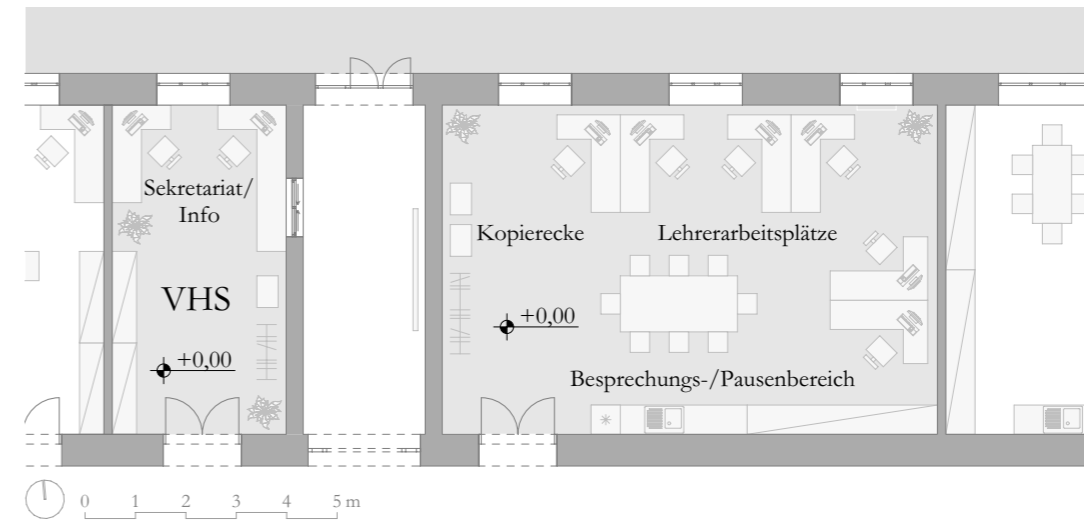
Grundriss Erdgeschoss (Detail Sekretariat und Arbeitsplätze für Lehrende) M 1:150
